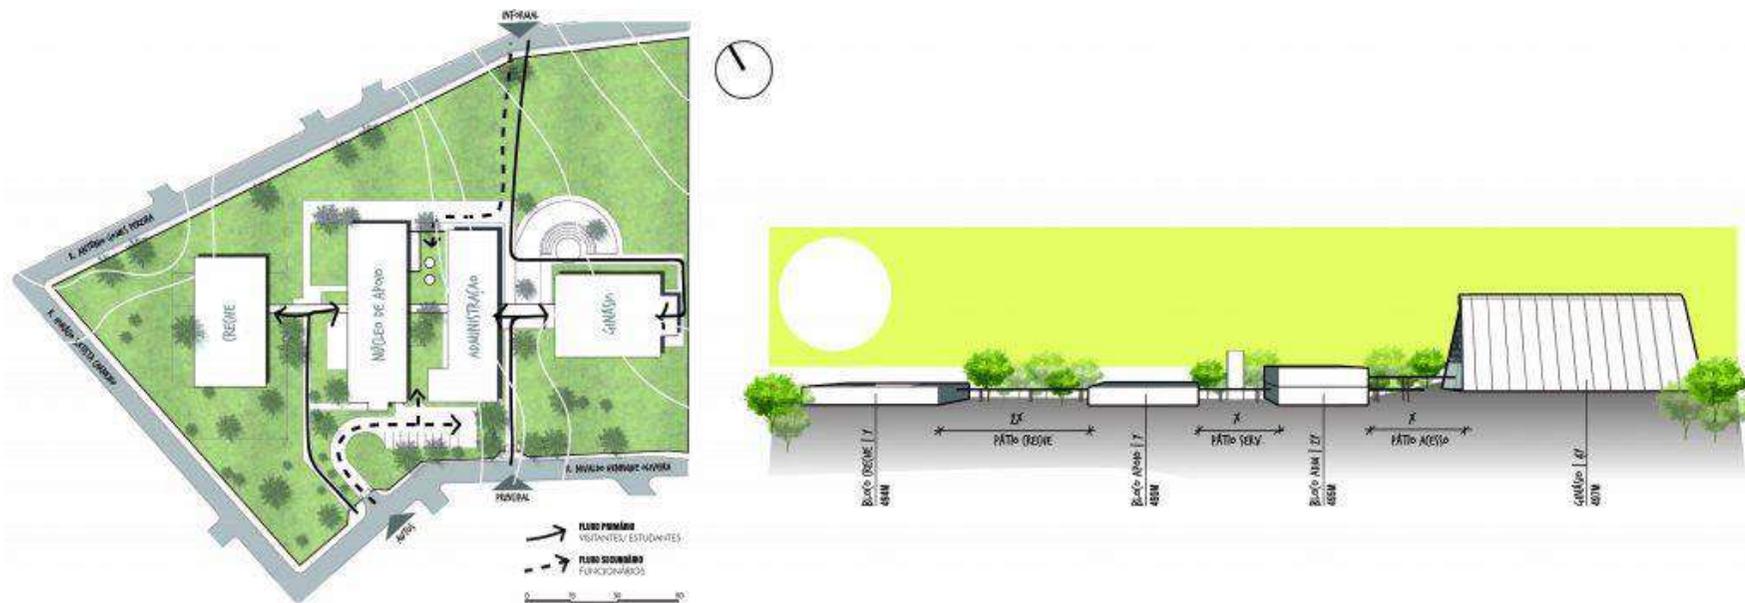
Complexo CAIC José Joffly em planta e corte esquemático.
